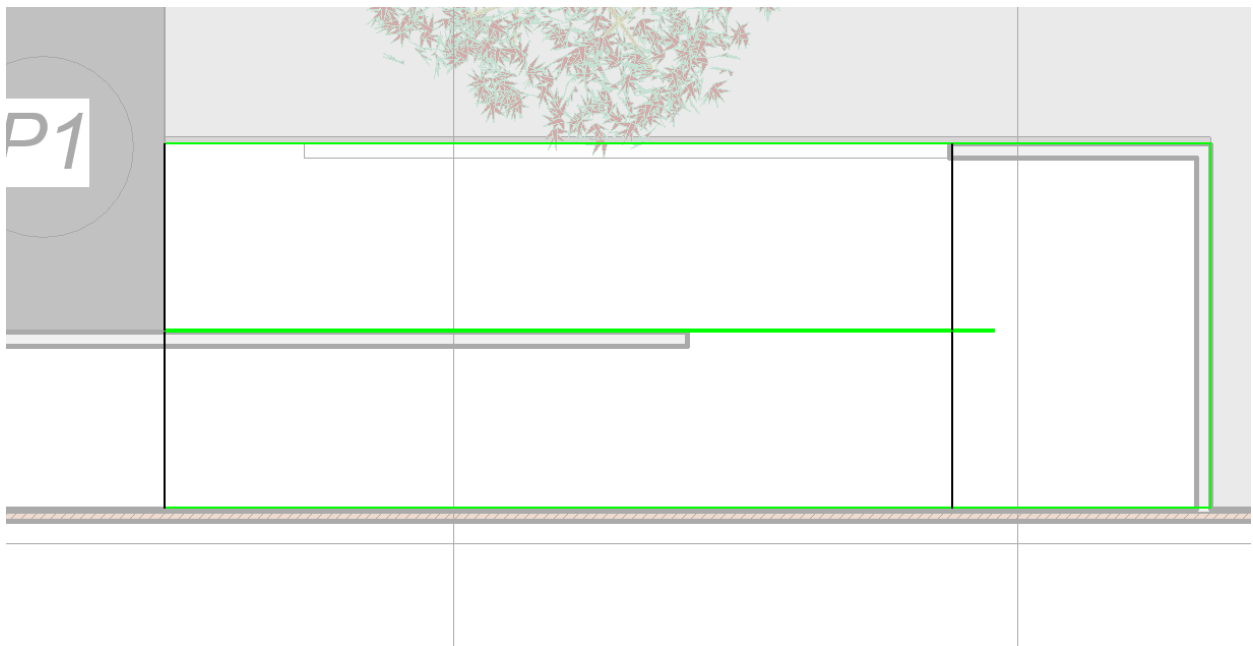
Vista en planta de la creación de rampas exteriores con contrahuellas en Revit
